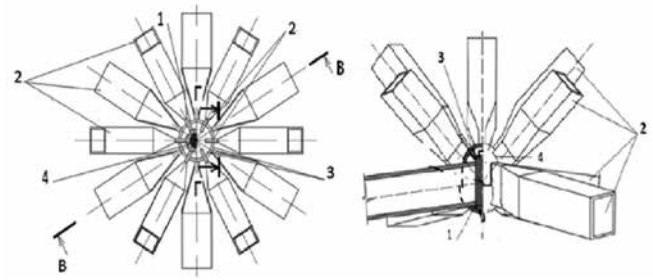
Вариант III узлового соединения элементов структуры: 1 – ванная сварка; 2 – трубчатые элементы пояса и решётки, 3 – узловой элемент; 4 – сварка на узловом элементе
